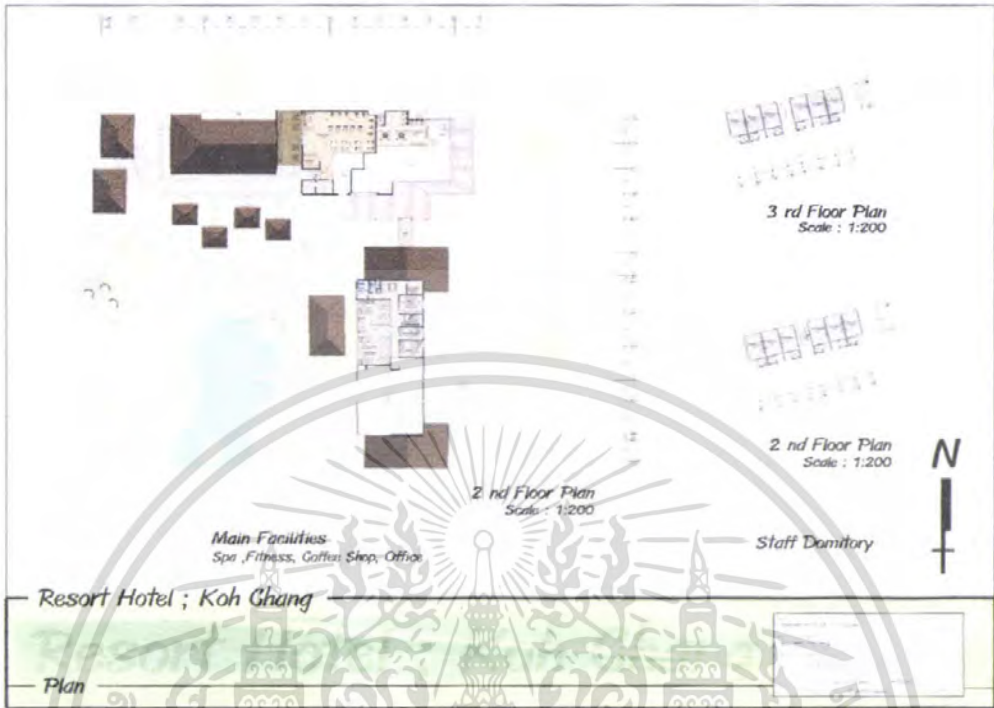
แสดงผังบริเวณ โครงการ (Lay-Out Plan)
